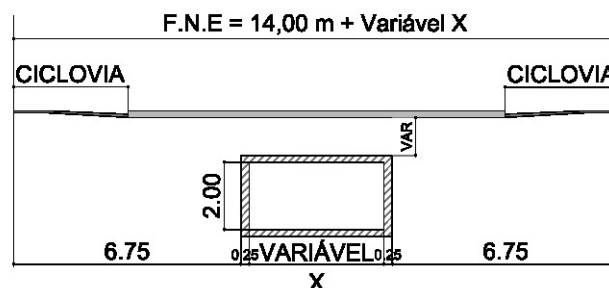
Canal em Concreto. Seção retangular fechada.
